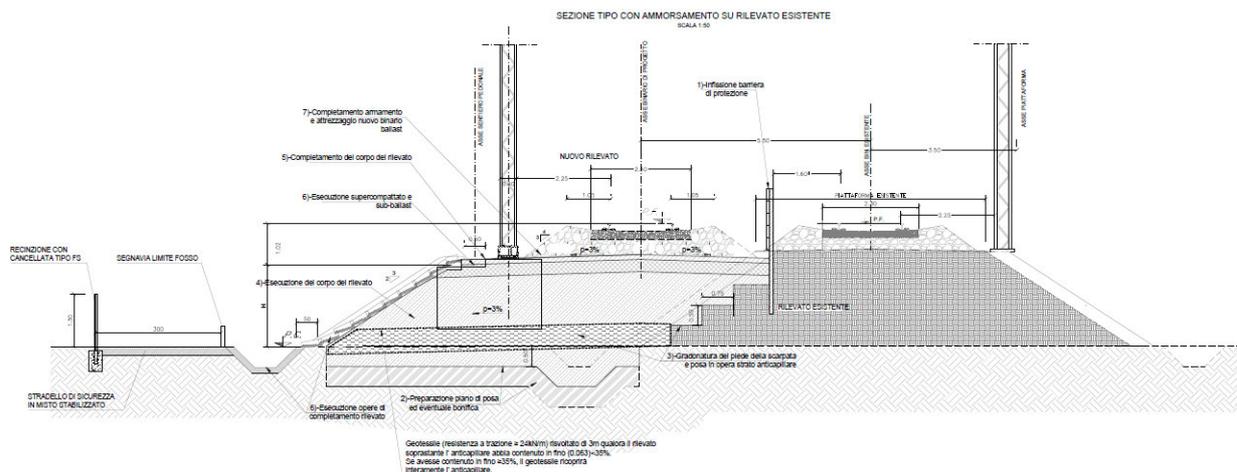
Corpo stradale ferroviario – Sezione tipo tratto in stretto affiancamento con la linea storica (oggetto di dismissione)
